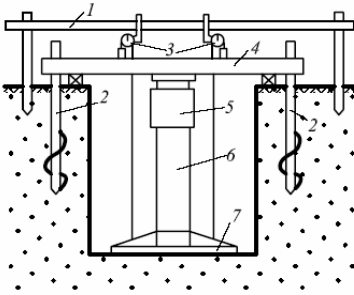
Штамповая установка с упором в балку, закрепленную анкерными сваями:
